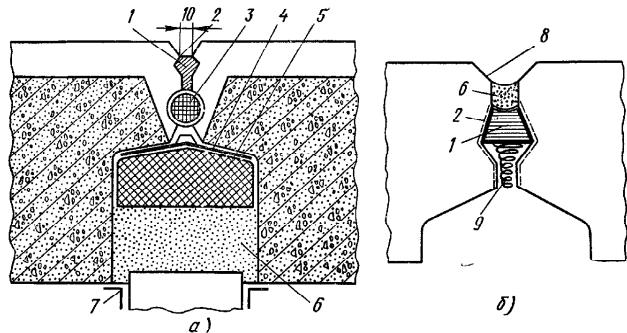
Стыки наавесных панелей наружных стен в промышленных зданиях:
